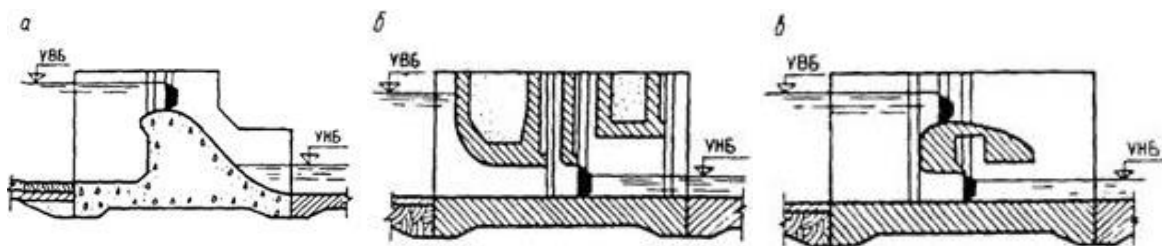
Основные виды водосбросных плотин на не скальном основании
